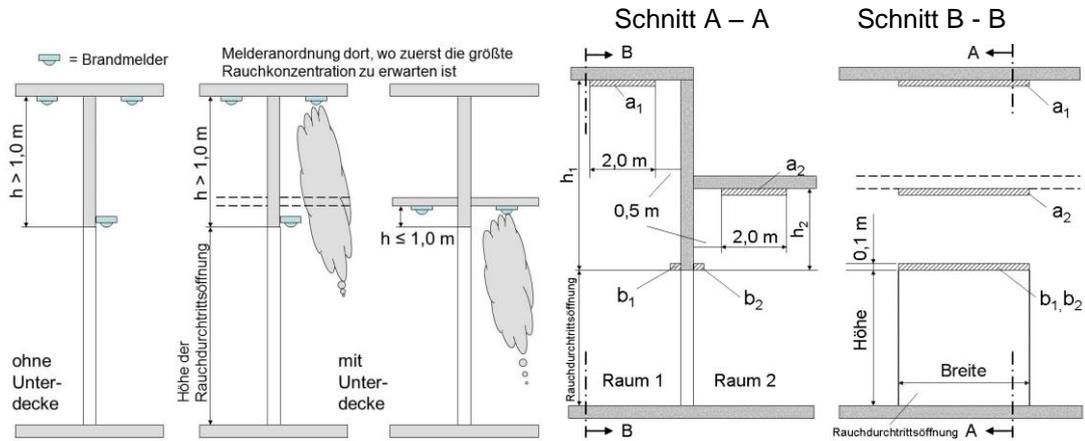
Maßgebende Höhe der Deckenunterfläche Bild 2: Installationsbereiche
